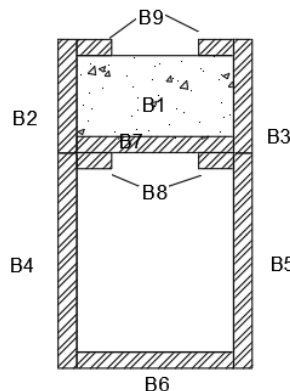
Viga compuesta rellena, Sección N°2 o principal.
